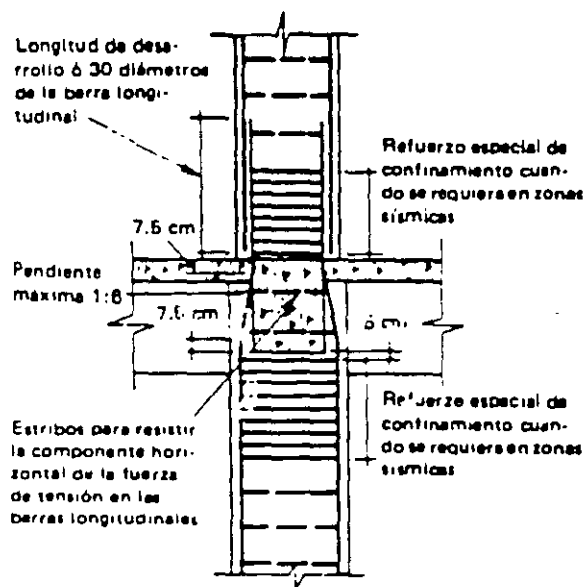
Detalles del refuerzo en los cambios de sección de columnas.
